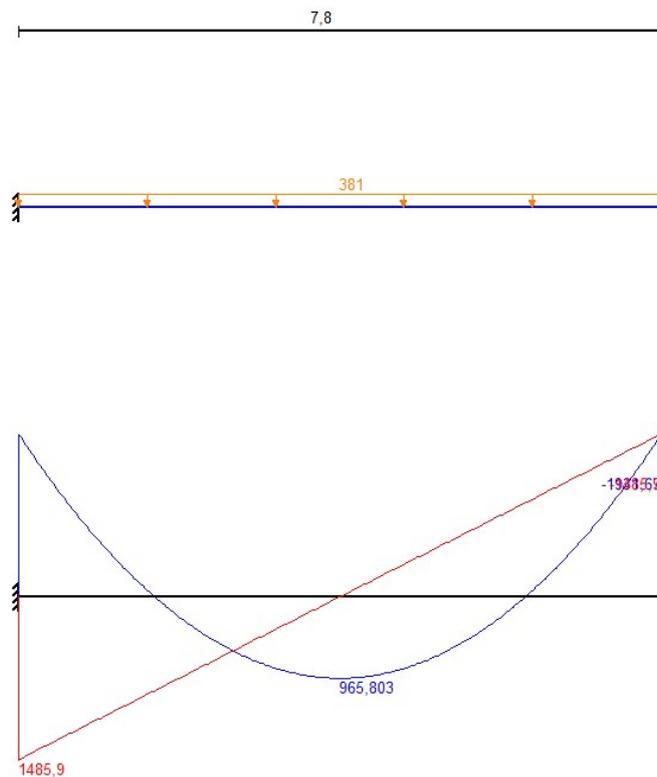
Схема приложения постоянной нагрузки на балку покрытия
